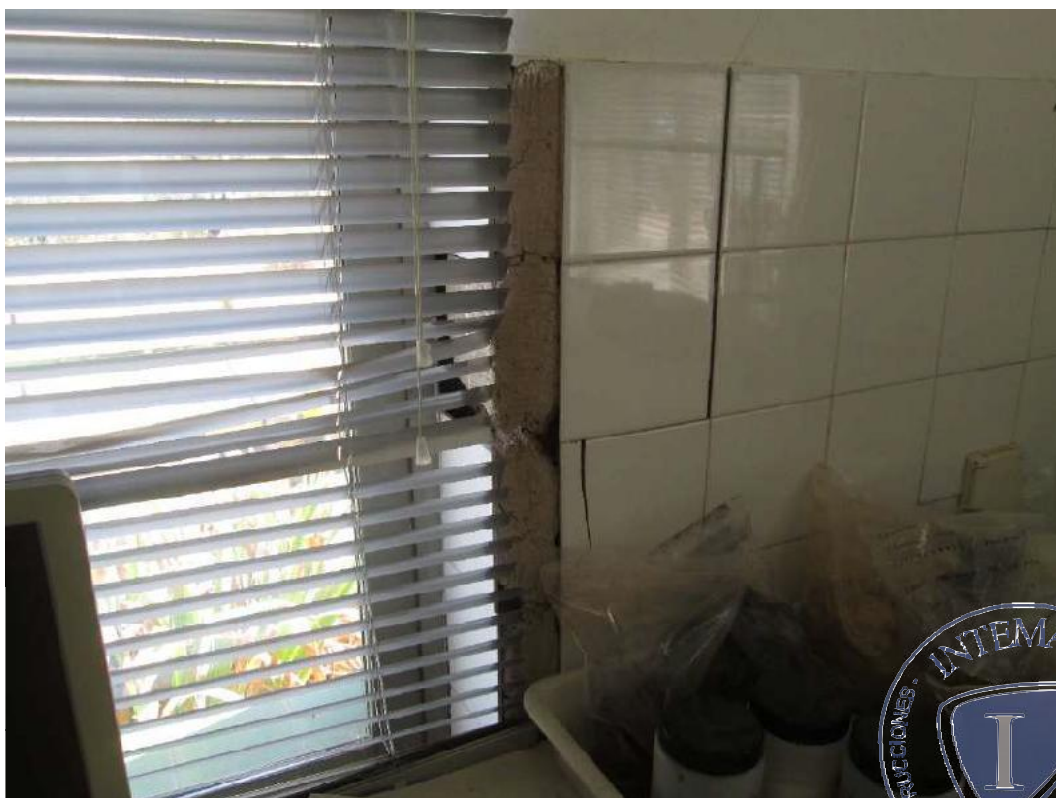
fisura inclinada y horizontal en el encuentro con el forjado superior, hoja interior del cerramiento.
